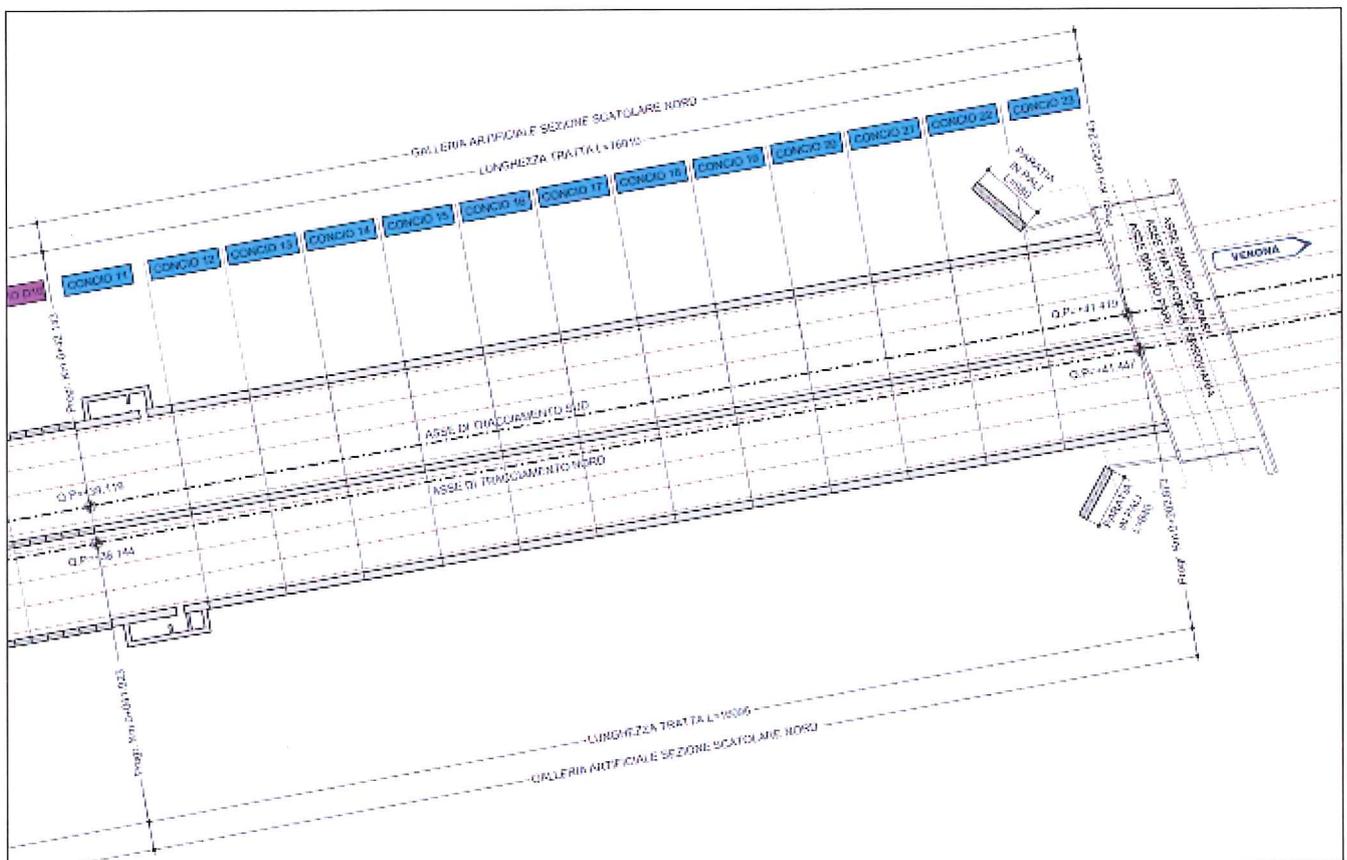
Planimetria generale dell'intervento - Tratto pk km 0+41.923 ÷ 0+202.873 (conci 11 - 23)
